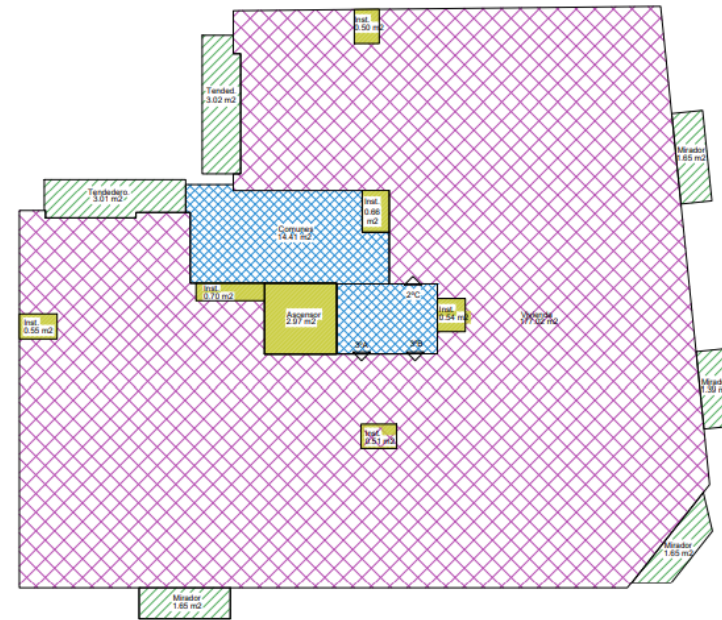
Imagen del plano de superficie construida de planta baja, entreplanta y sótano. (Fuente: GREEN SOLID S.L)
